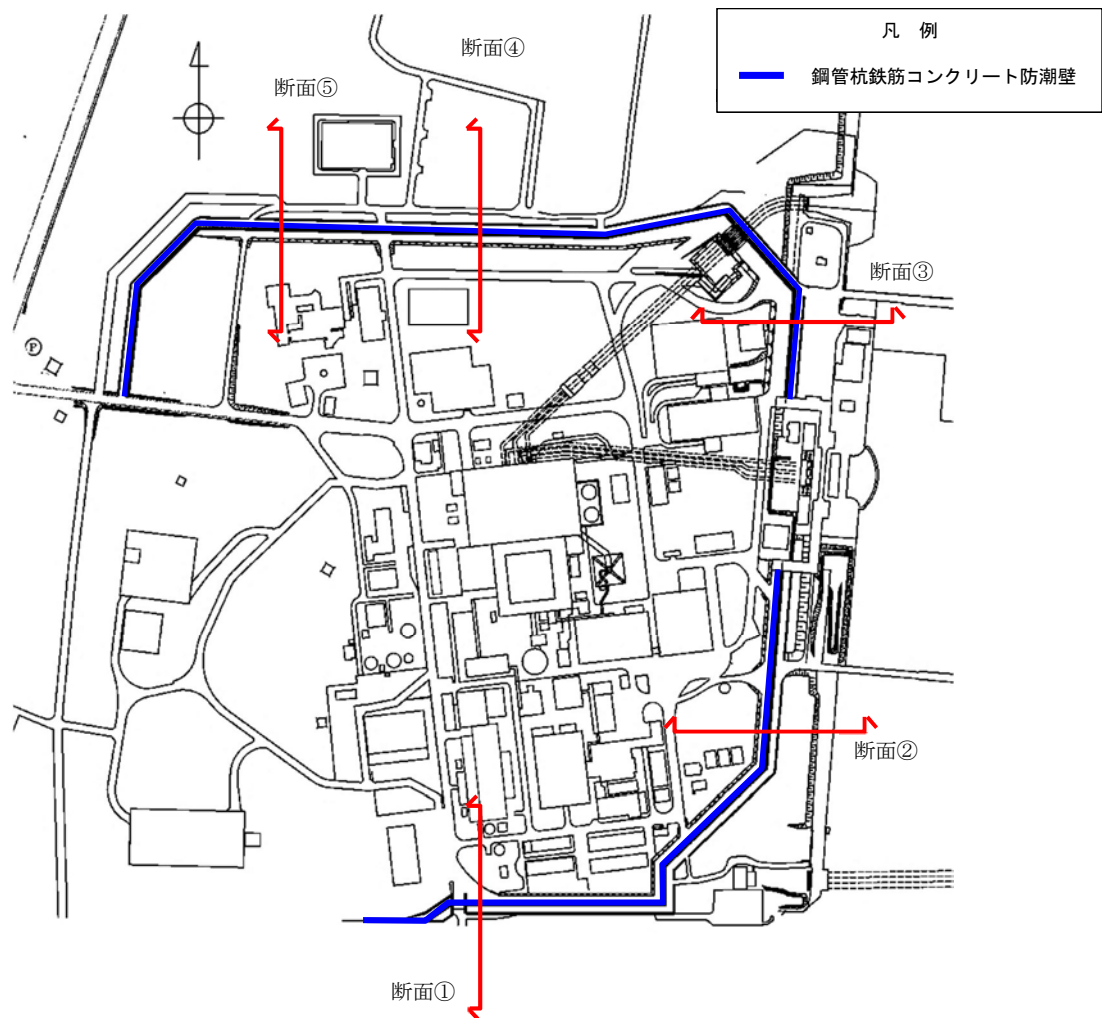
鋼管杭鉄筋コンクリート防潮壁位置図
